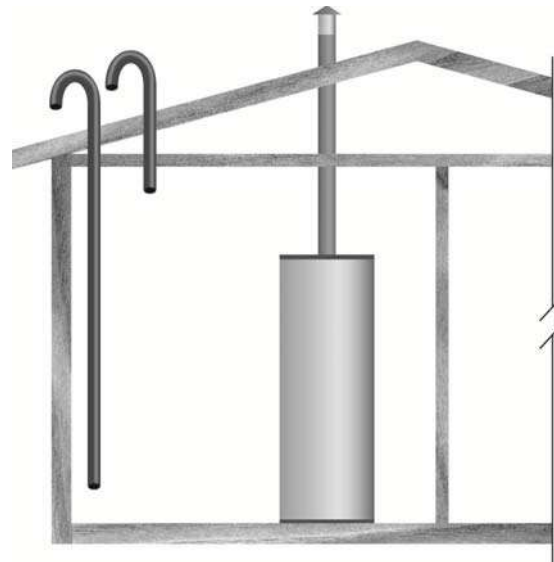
AIR FRAIS PAR DEUX CONDUITS VERTICAUX
